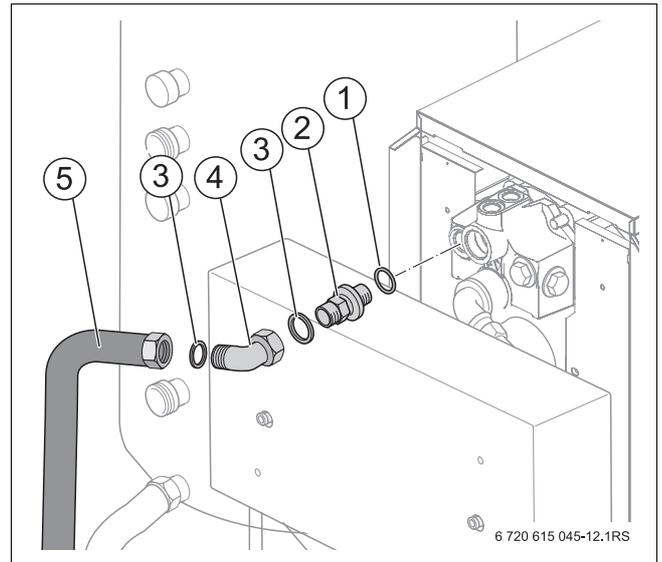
Vorlaufanschluss am Heizkessel montieren bei rechts nebenstehendem Warmwasserspeicher
